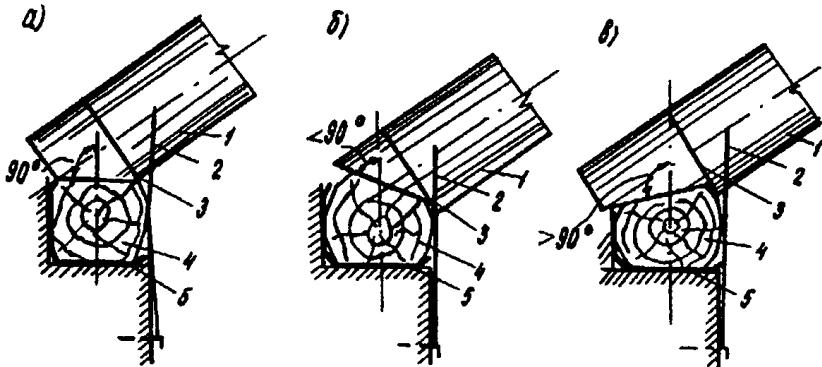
Правильное (а) и неправильное (б) и (в) выполнение опирания наслонной стропильной ноги на мауэрлат:
